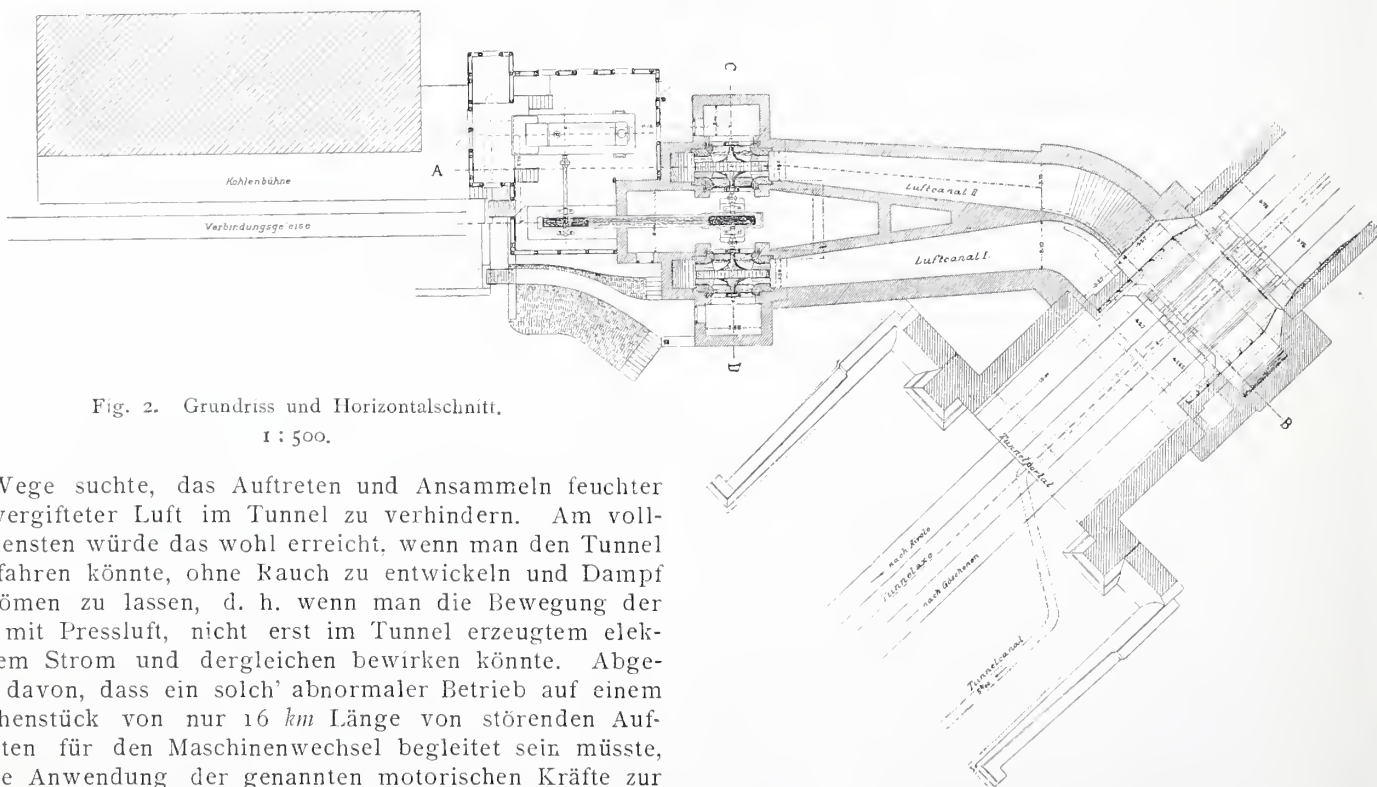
Grundriss und Horizontalschnitt.
